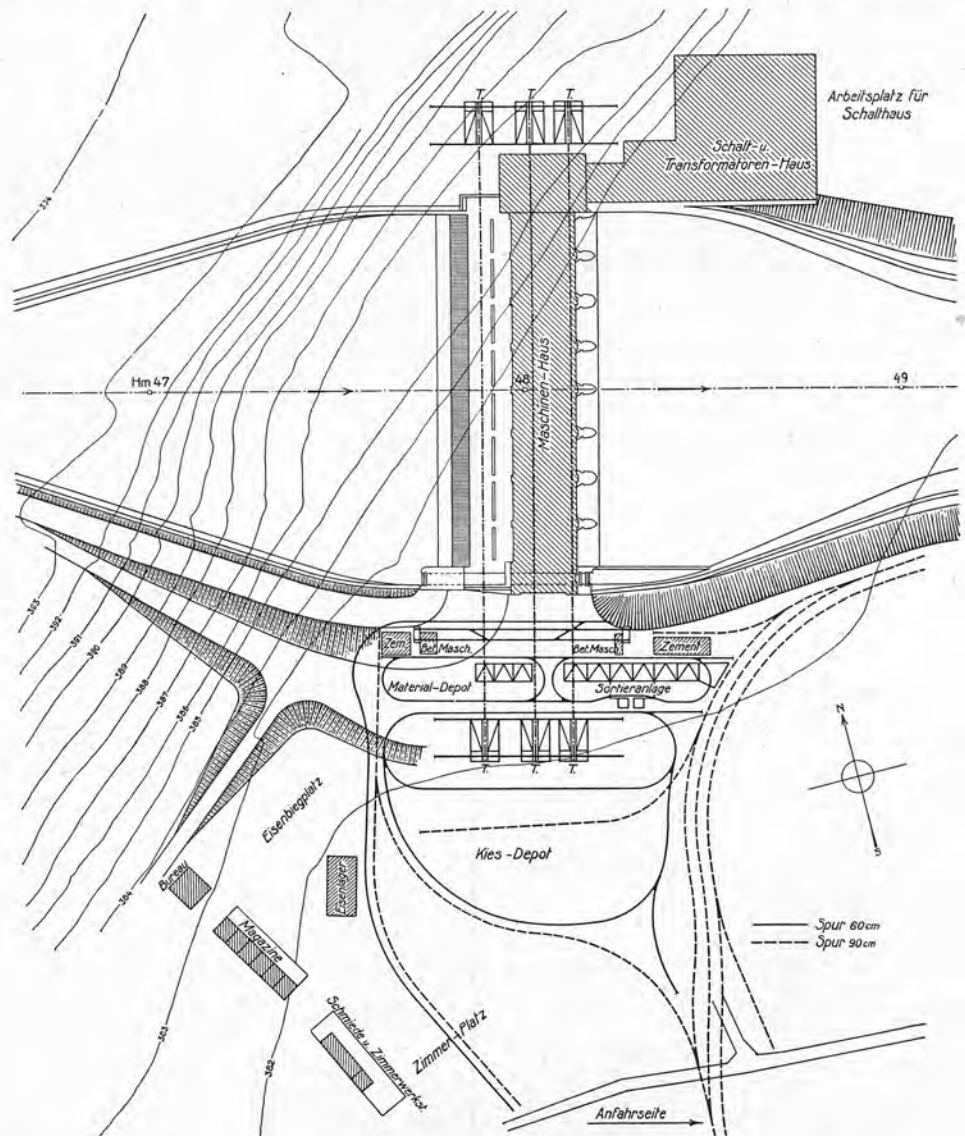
Lageplan des Maschinen- und des Schalhauses, mit Installationsplatz. — 1:2000.
